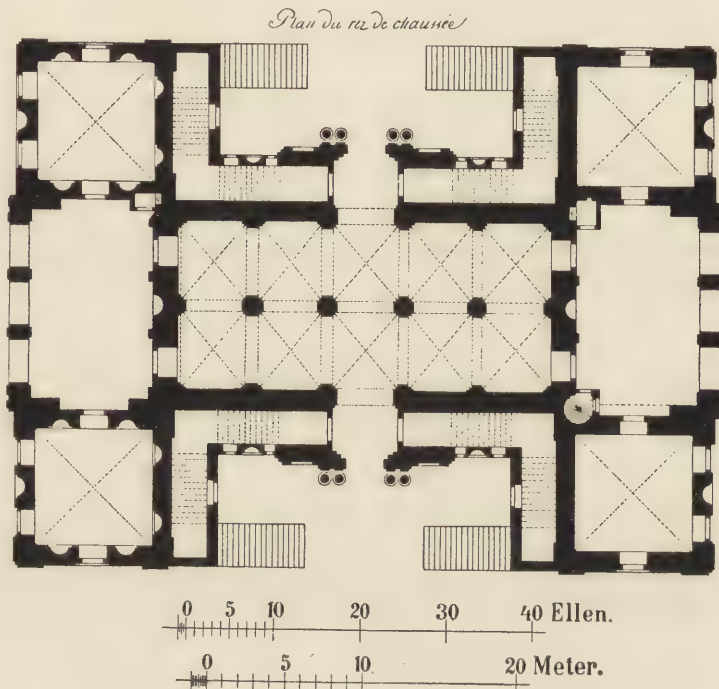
Palais im Grossen Garten. Grundriss des Erdgeschosses.
